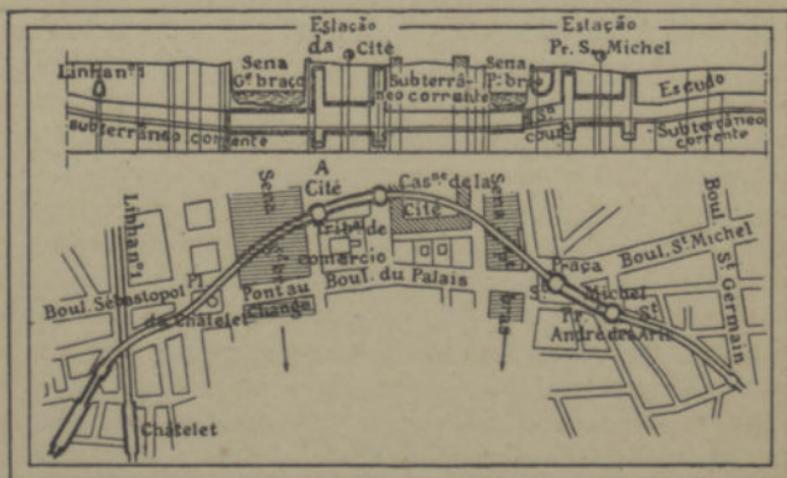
Planta e perfil longitudinal da travessia do Sena pela linha n.º 4
